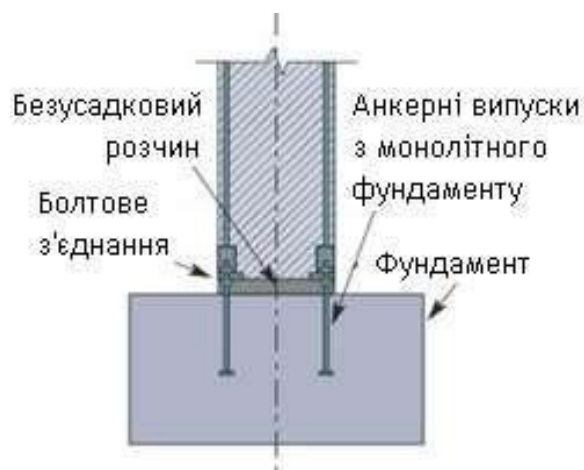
З'єднання закладних деталей колон з анкерними болтами фундаментів
